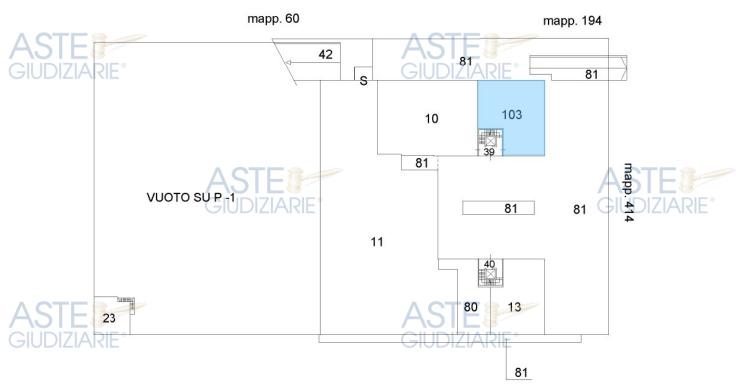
Individuazione unità immobiliari in oggetto su estratto elaborato planimetrico catastale -piano terra
